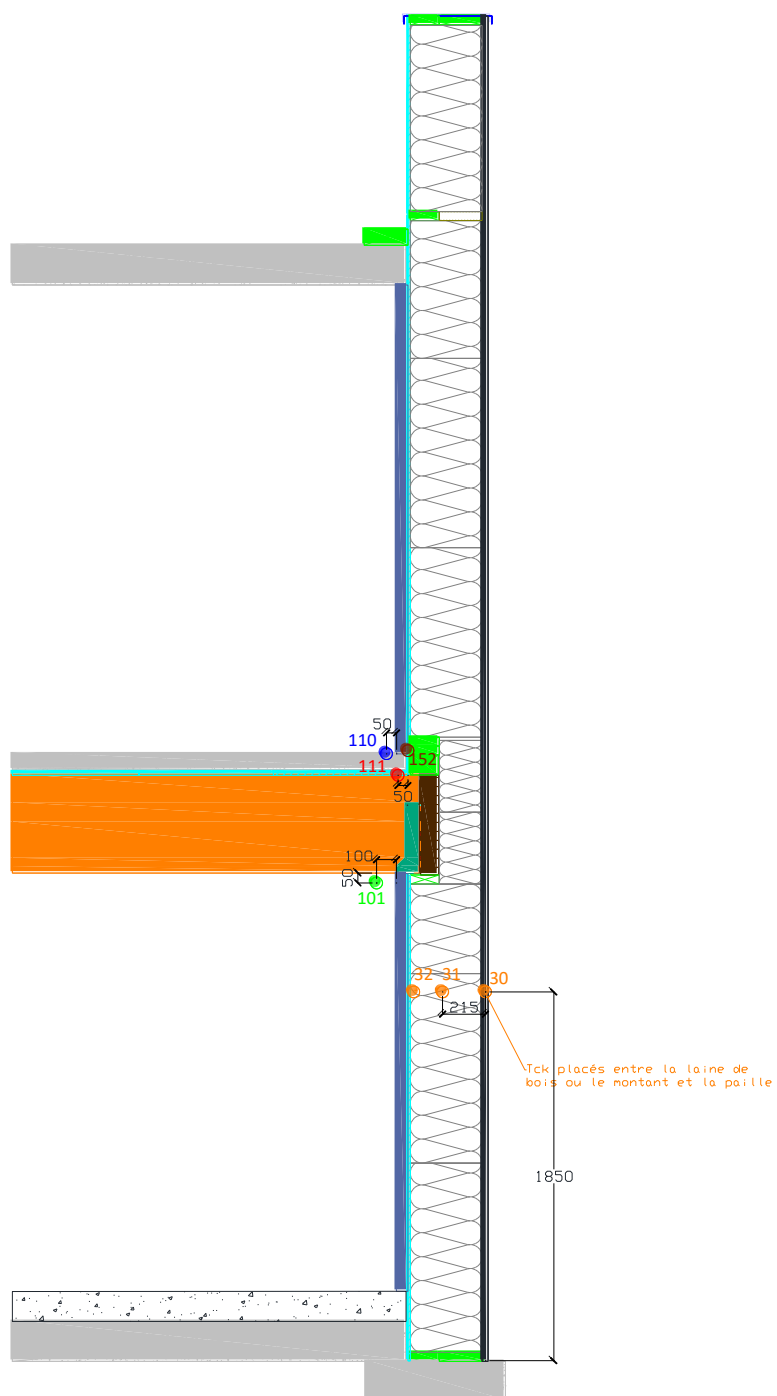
Instrumentation de l'élément de façade - Coupe K-K
